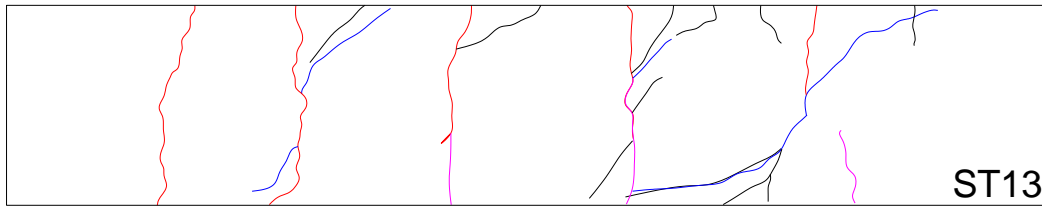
Profil de fissuration de la poutre ST13
